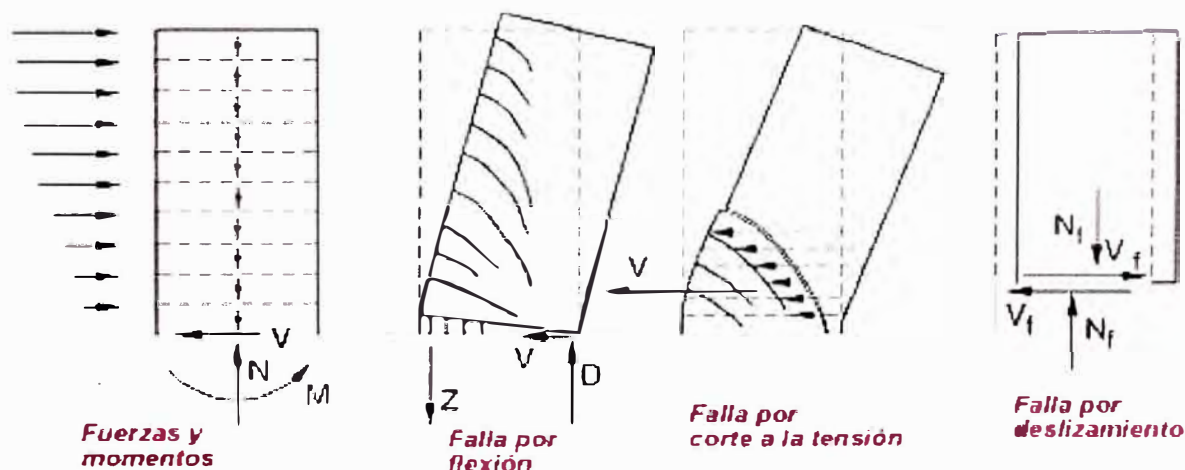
Modos de Falla en Muros de Concreto Armado <sup>(1)</sup>.
